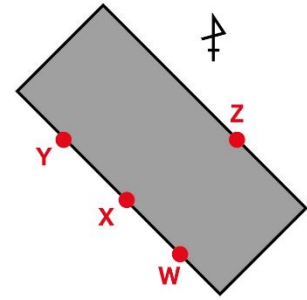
2-1p と 2-2x のひび割れ幅計測ポイント位置
